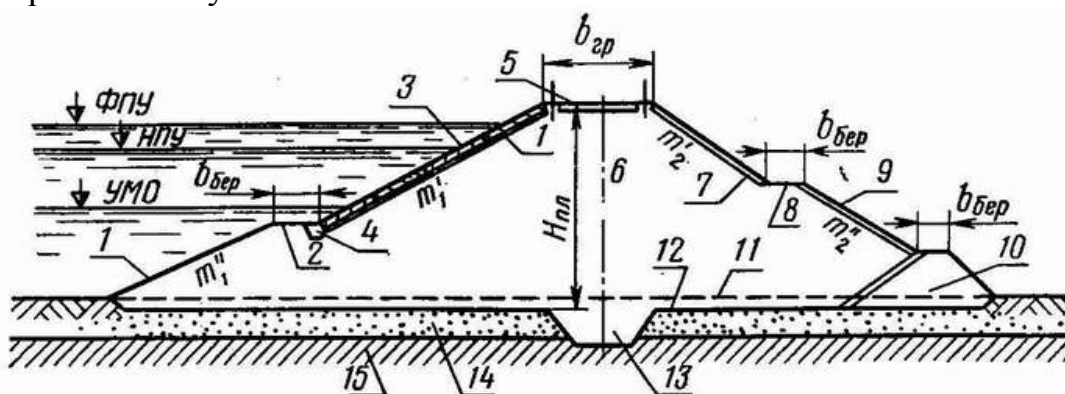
Поперечный профиль грунтовой плотины:
